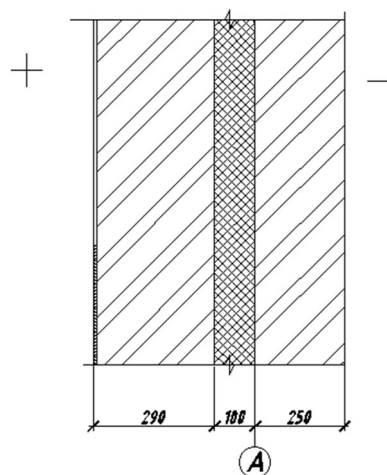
Расчетная схема стеновой ограждающей конструкции
